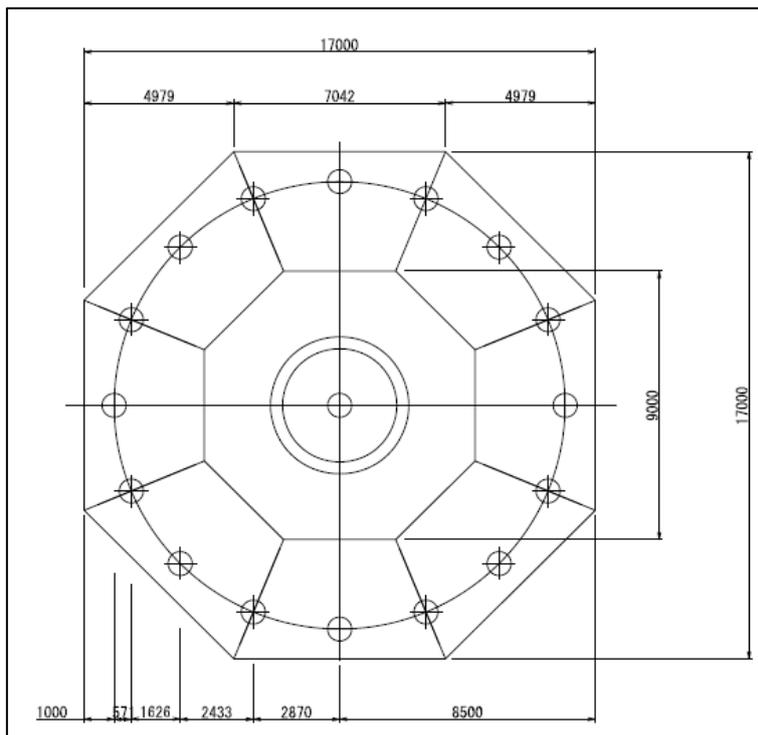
2. 7-1(2) 基礎構造概要図 (平面図)
